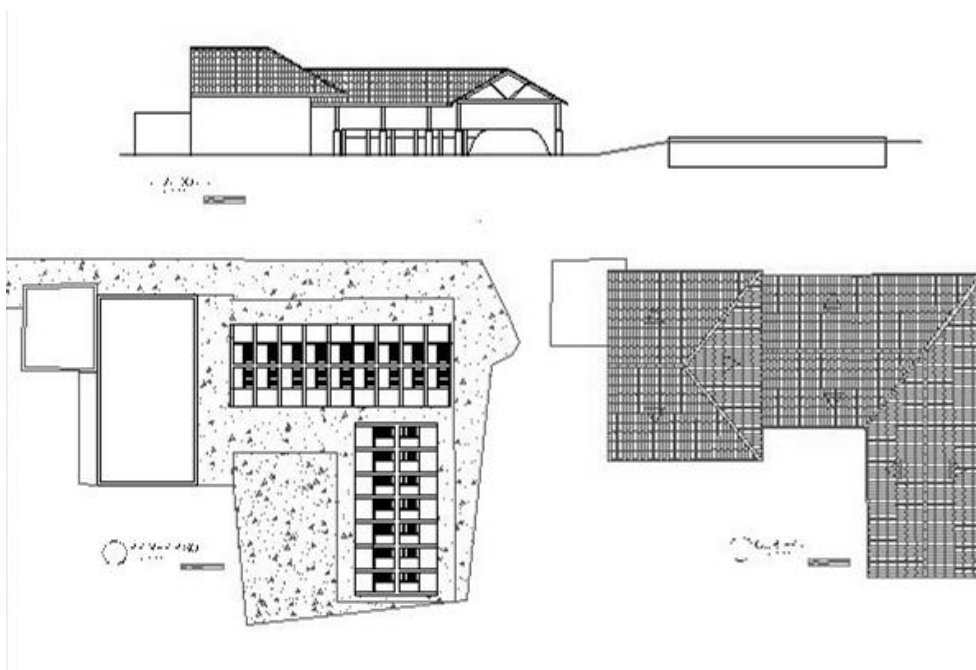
Planta primer nivel, planta de cubierta y alzado de los lavaderos comunitarios. Levantamiento realizado en el transcurso del proyecto.
